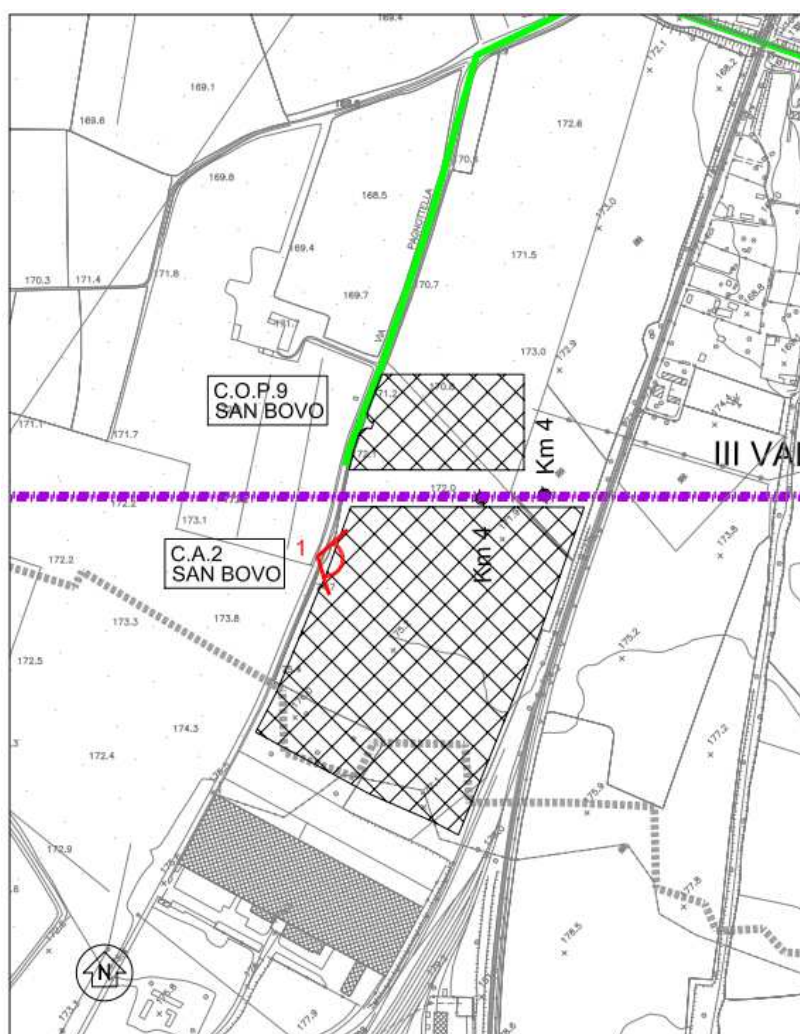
Stralcio planimetrico con indicazione dell'ubicazione del cantiere di Armamento C.A.2 per la soluzione di Progetto Definitivo
